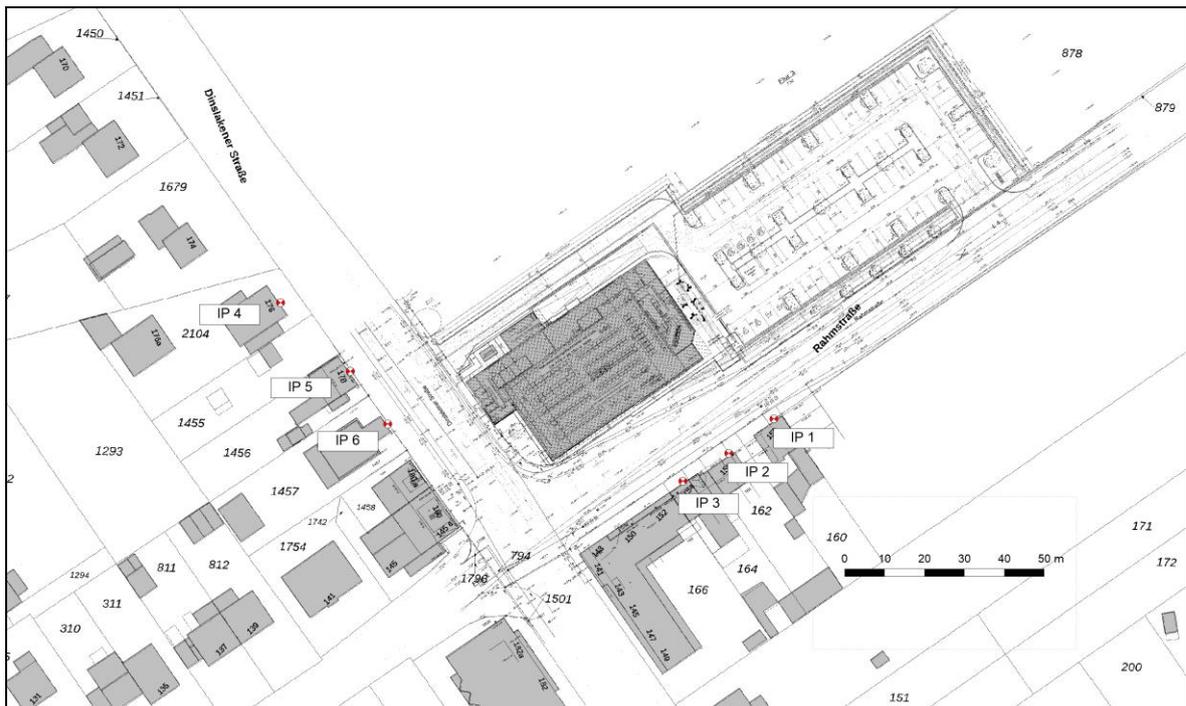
Lageplan mit Kennzeichnung der Immissionspunkte
